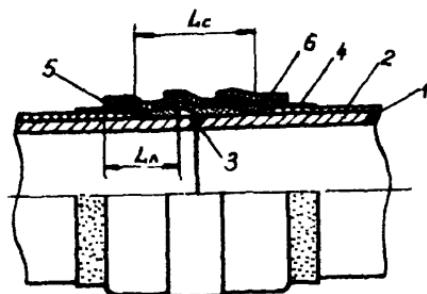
Изоляционное покрытие зоны сварного стыка полимер-
